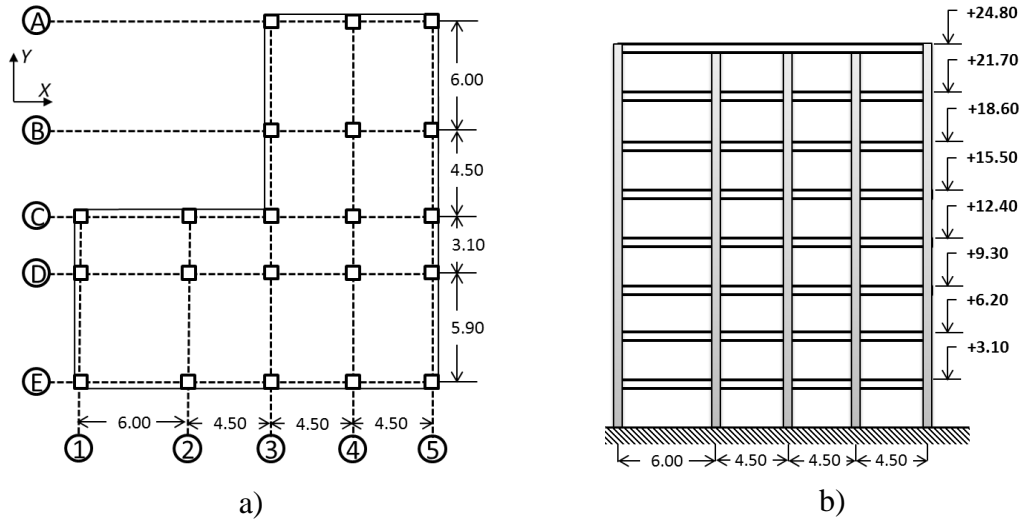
Planta y alzado de edificio de ocho niveles (dimensiones en m)
